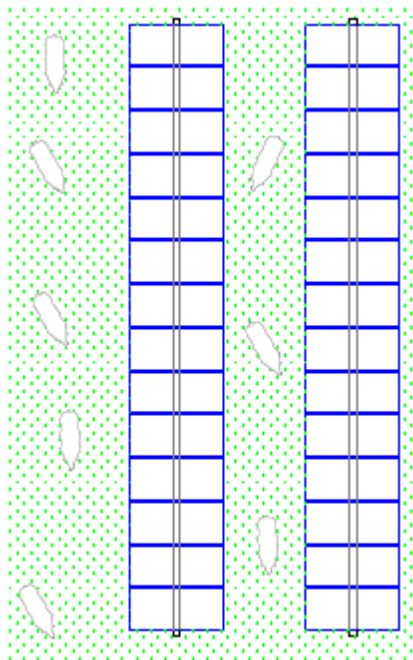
Piantumazione tra le file di tracker (vista dall'alto)
